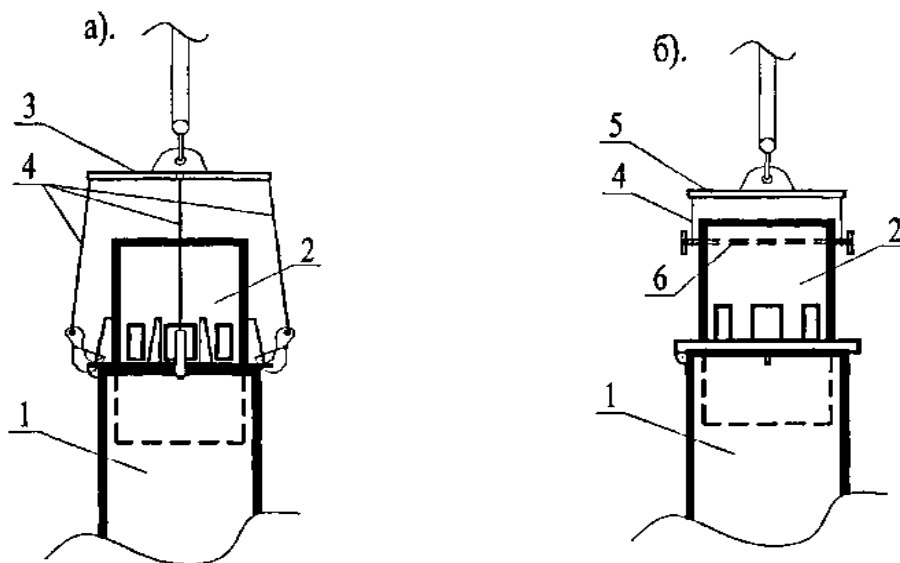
Схеми стропування монтажних елементів хрестовою траверсою за опорний «комір» (а) і пальцевим захопленням (б)
